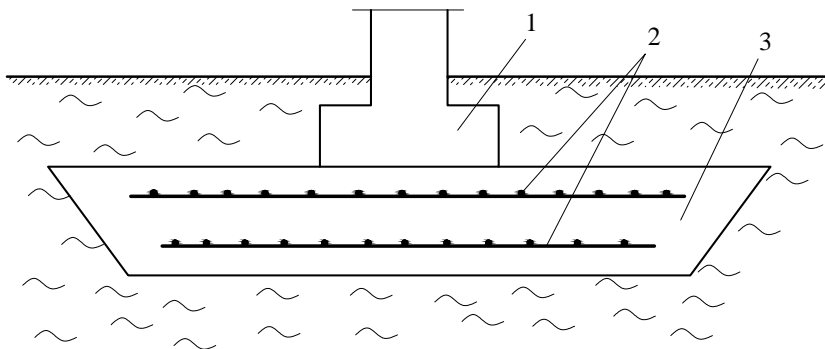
Схема підсилення основи фундаменту армованою подушкою: 1 – фундамент; 2 – армувальні сітки; 3 – ґрунт подушки
